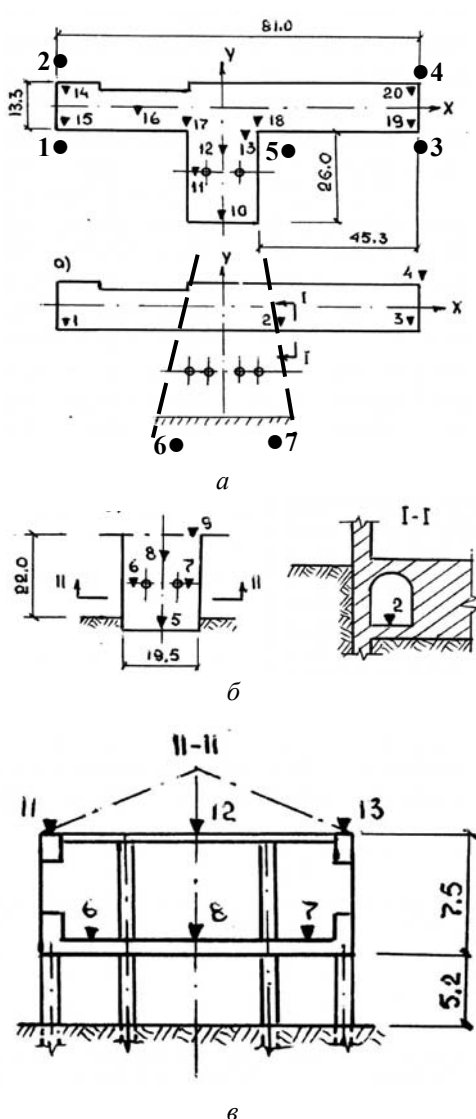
Ситуационная схема испытаний здания железнодорожного вокзала: а – основание здания; б – пол перехода к привокзальной площади; в – потолочное перекрытие; ▼₁₀ – точка измерения вибрации и ее порядковый номер; — — — — — граница водонасыщенной зоны грунтов
